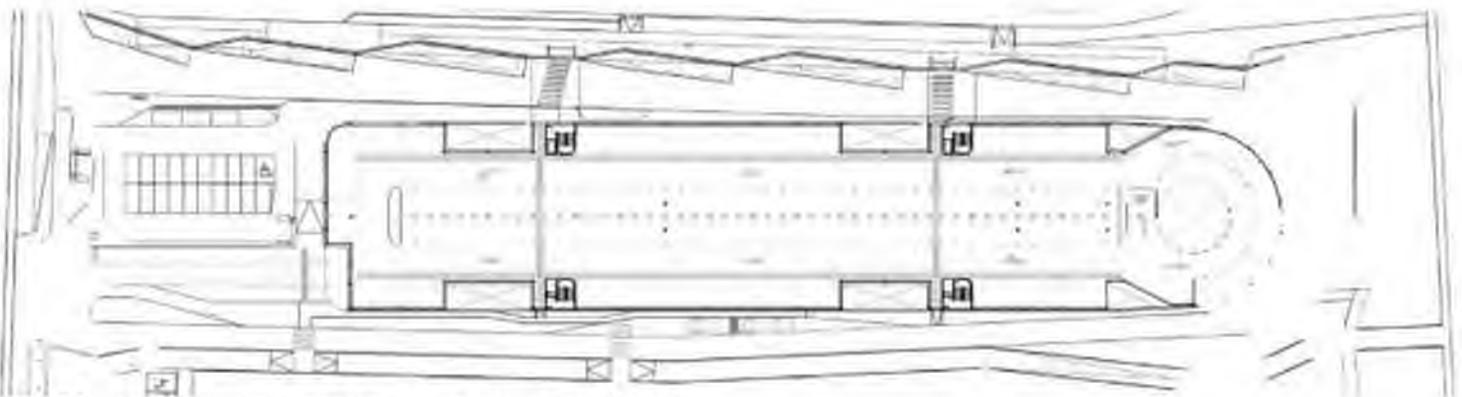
PARKING AND INTERMODAL STATION. Archdaily
